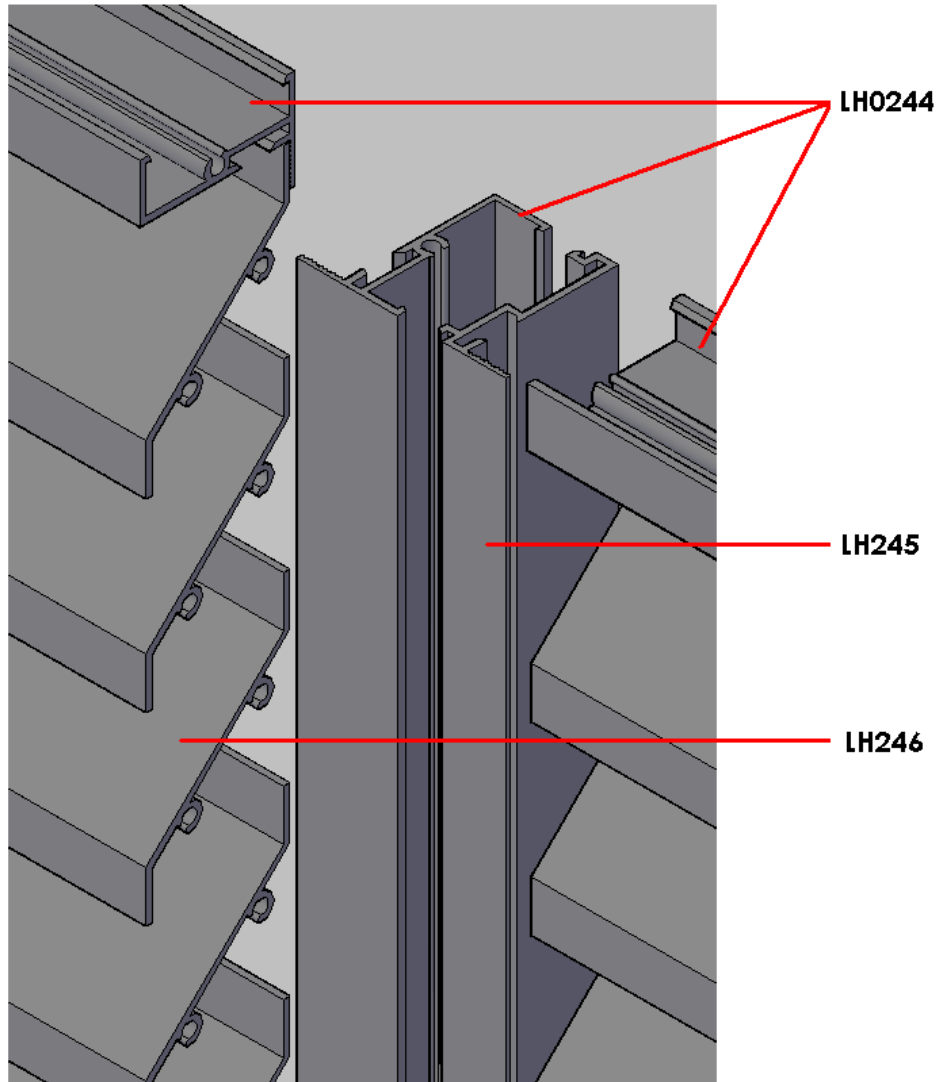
Detalle de instalación de perfilera en aplicación unión de rejillas.
